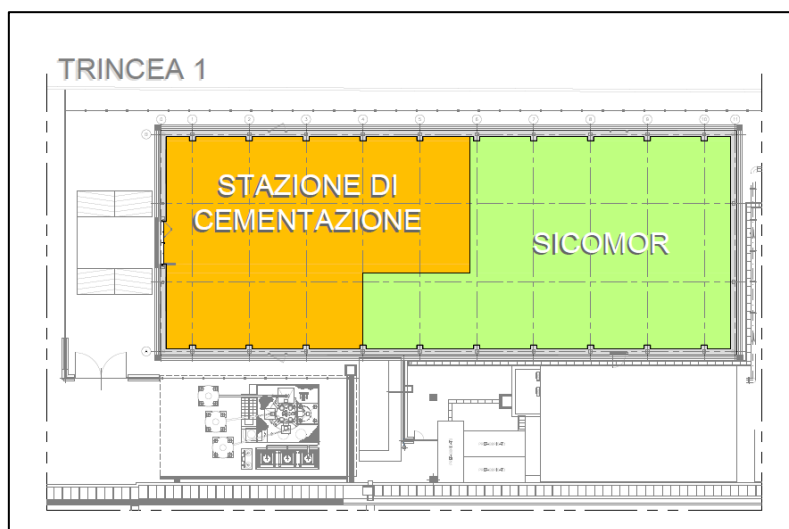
Collocazione della stazione di Grouting nella Trincea 1 (rif. elaborato GRSC00198_rev00)
